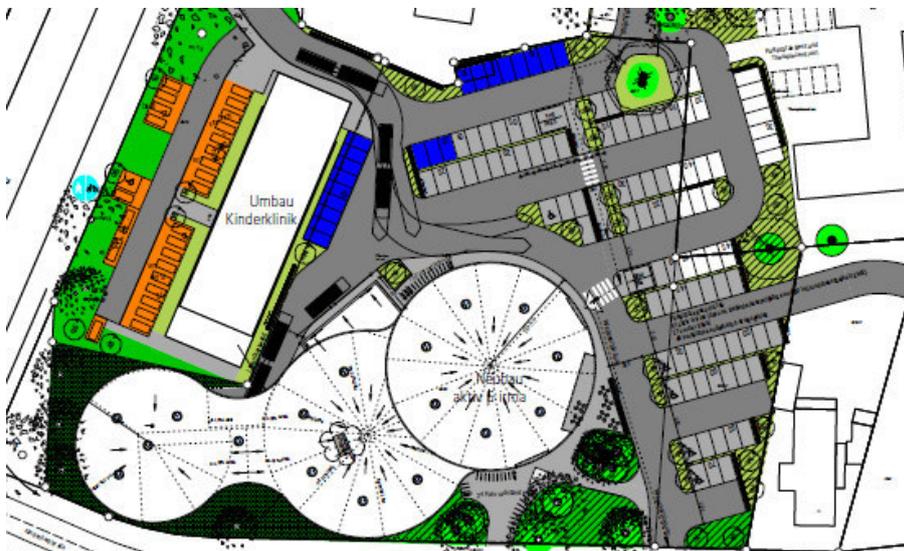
Lageplan (Projekt B)⁴⁰⁴
